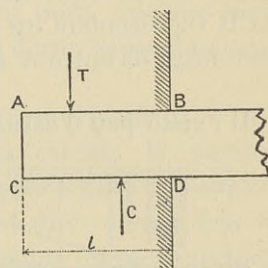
Encastrement d'une poutre dans un mur en maçonnerie.
